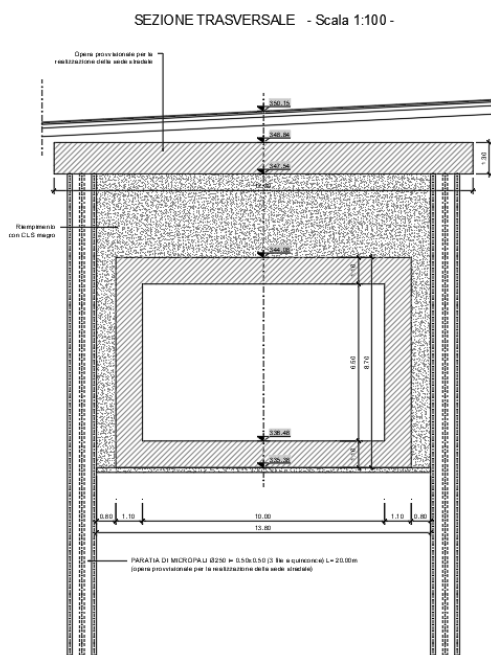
Sezione dell'attraversamento fosso dei Cerri B.108 in progetto.
